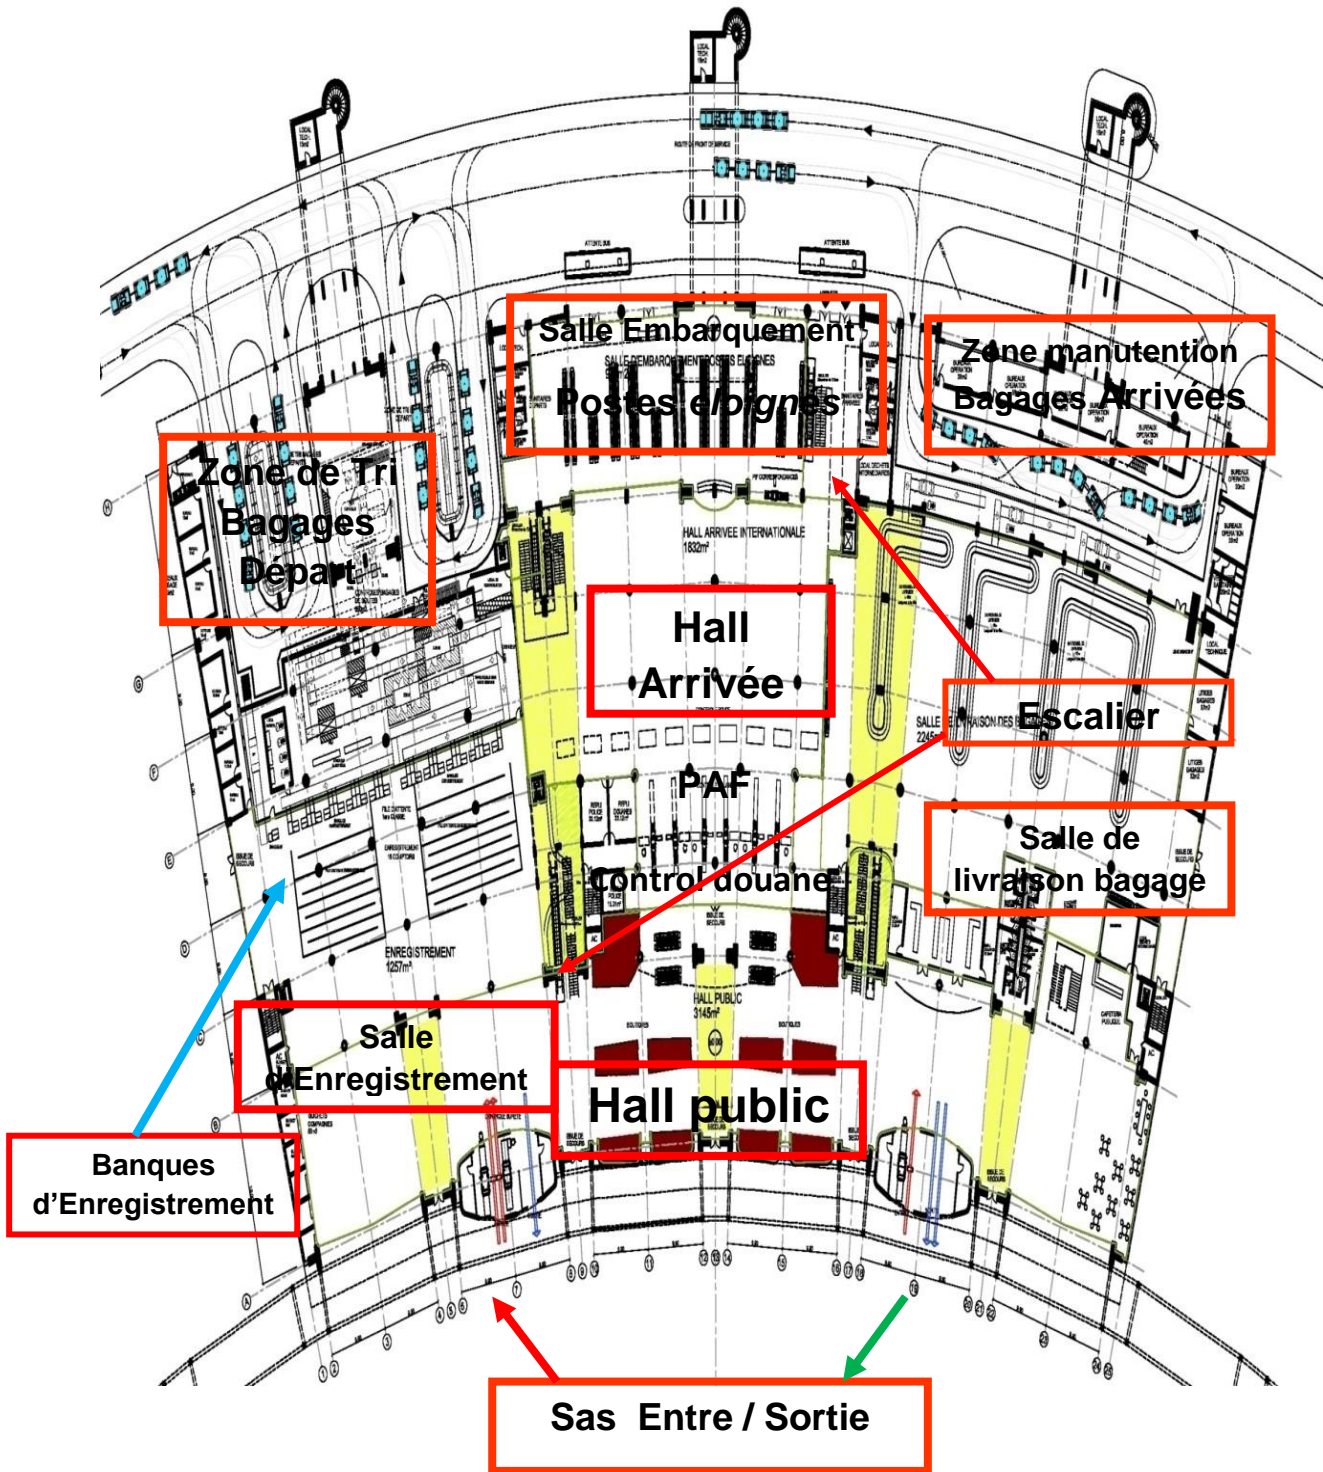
Nouvelle Aérogare internationale – Plan du rez-de-chaussée
